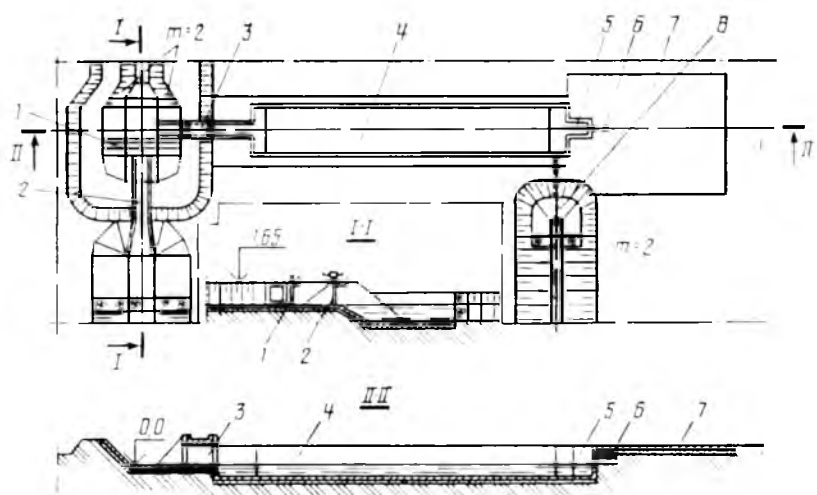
Рыбоуловитель прудового рыбоводного хозяйства: 1, 2 — рыбозадерживающее и перегородивающее сооружения; 3 — рыбовыпуск; 4, 5 — камеры рыбоуловителя и облова; 6 — патрубок; 7 — разгрузочная площадка; 8 — донный трубчатый водовыпуск
